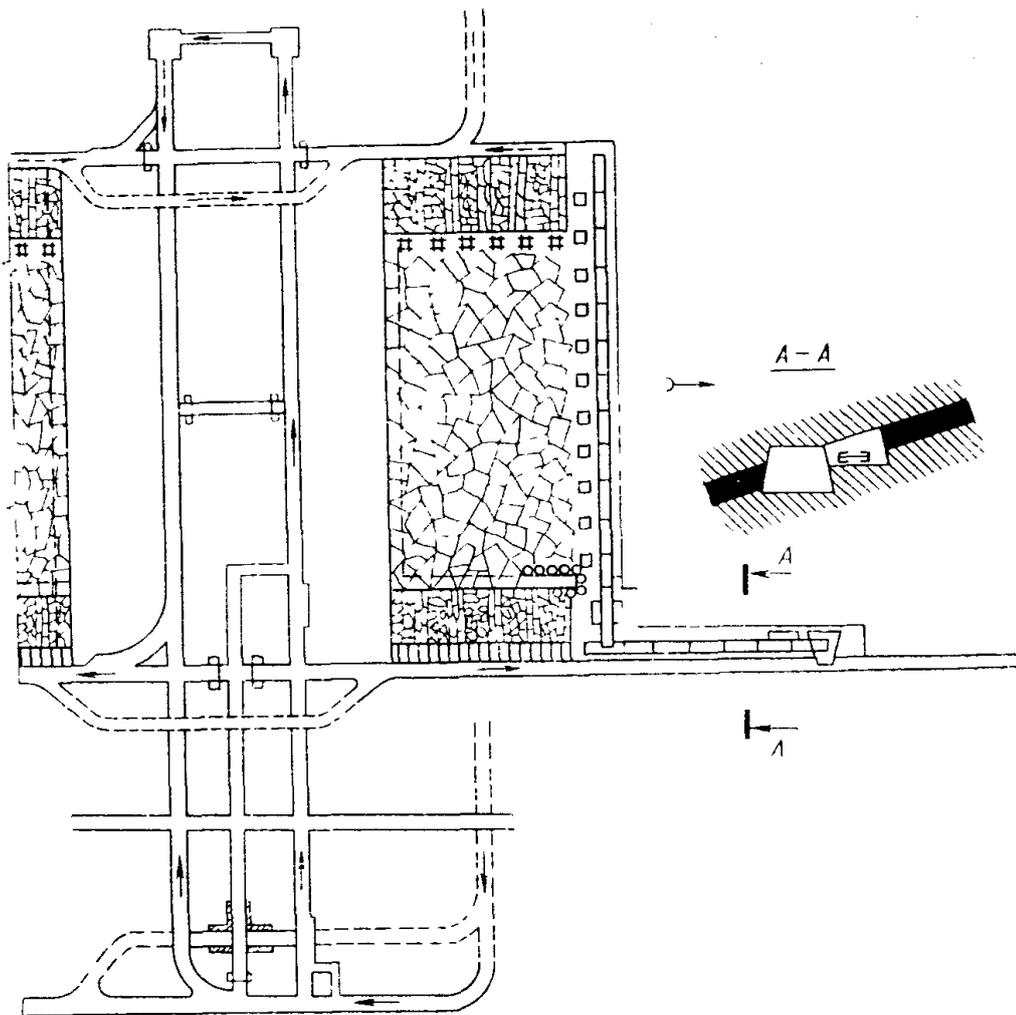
Схема транспорта угля из лавы на штрек через берму
